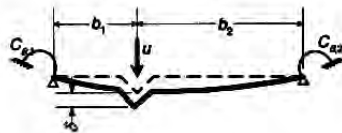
Elementi piani delimitati da due anime con irrigidimenti intermedi
